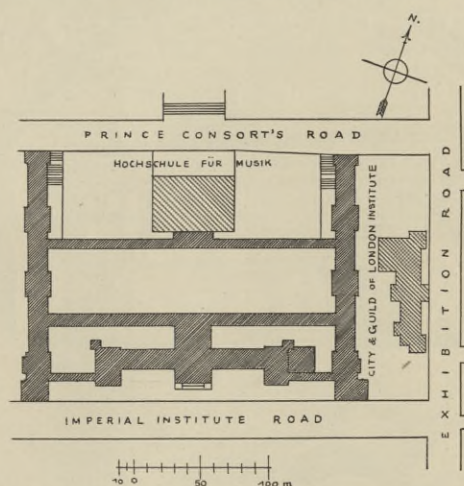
Lageplan der ausgeführten Teile des Imperial Institute nebst Seitengalerien.
